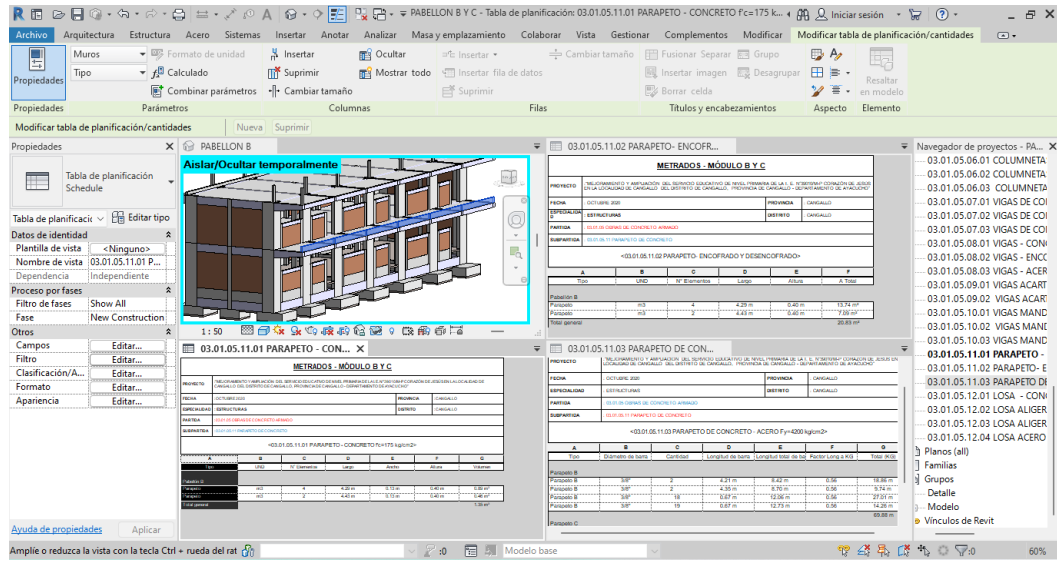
Modelado y metrados de la partida Parapeto de concreto Modulo B y C.
